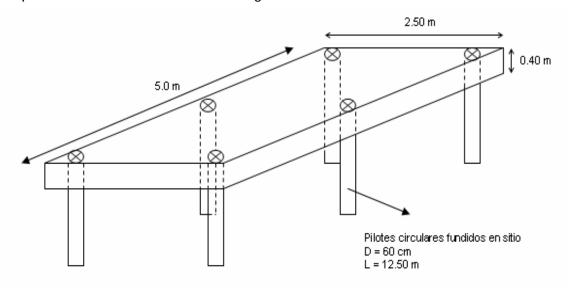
Losa cabezal y Pilotes para Cimentar los Generadores - Pilotes de 60 cm de Diámetro - Estación Matías Hernández
